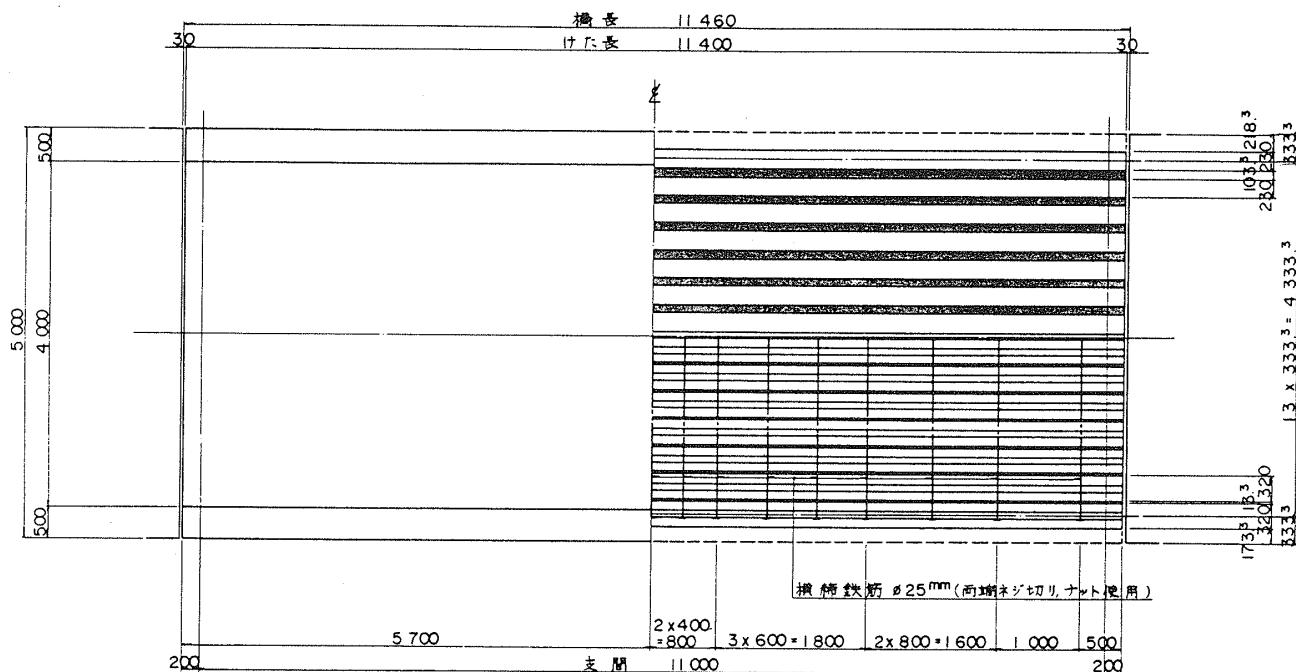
スラブ橋用PC橋げた設計例¹⁹⁾
